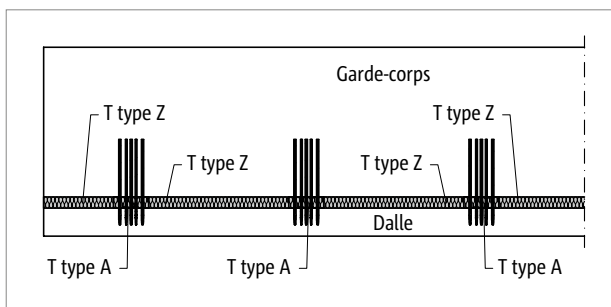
Schöck Isokorb® T type A disposition horizontale : projection horizontale avec garde-corps posé en avant
